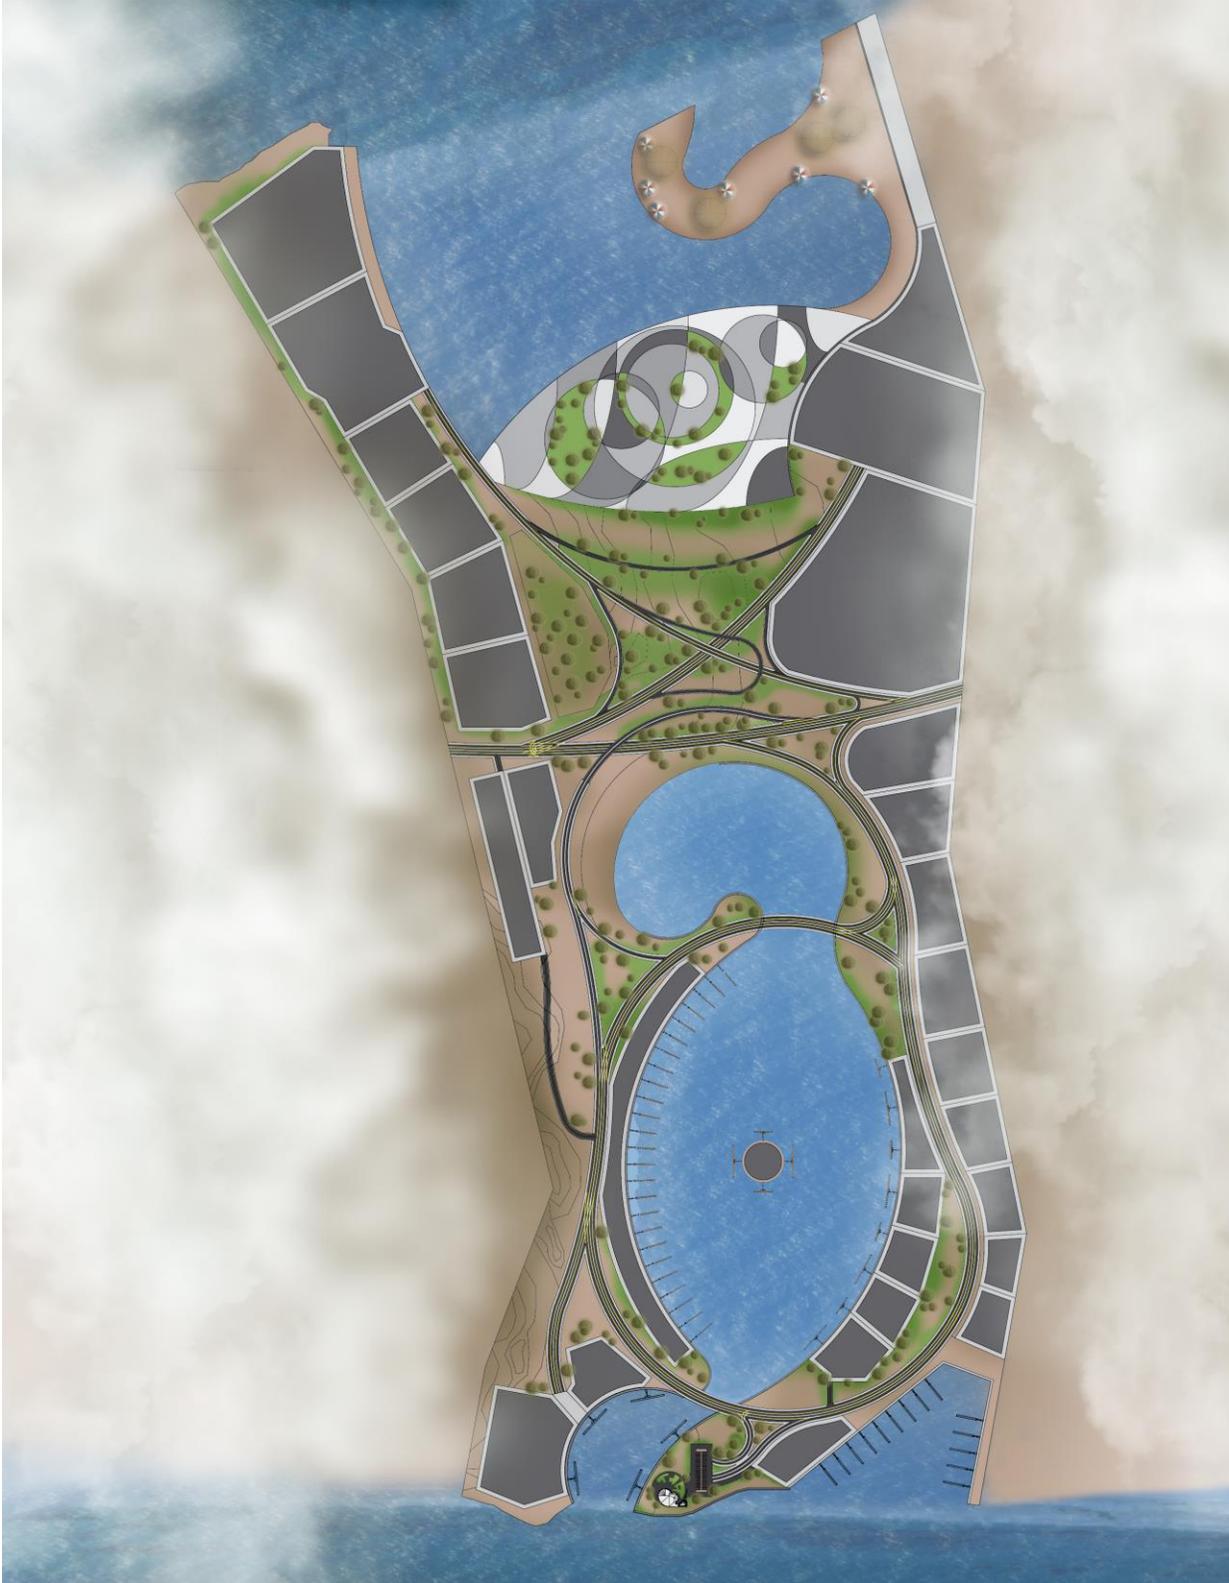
"Partido esquemático", la propuesta de la disposición de áreas es para facilitar la comunicación entre ellas. Archivo personal, Ramón Meza.
